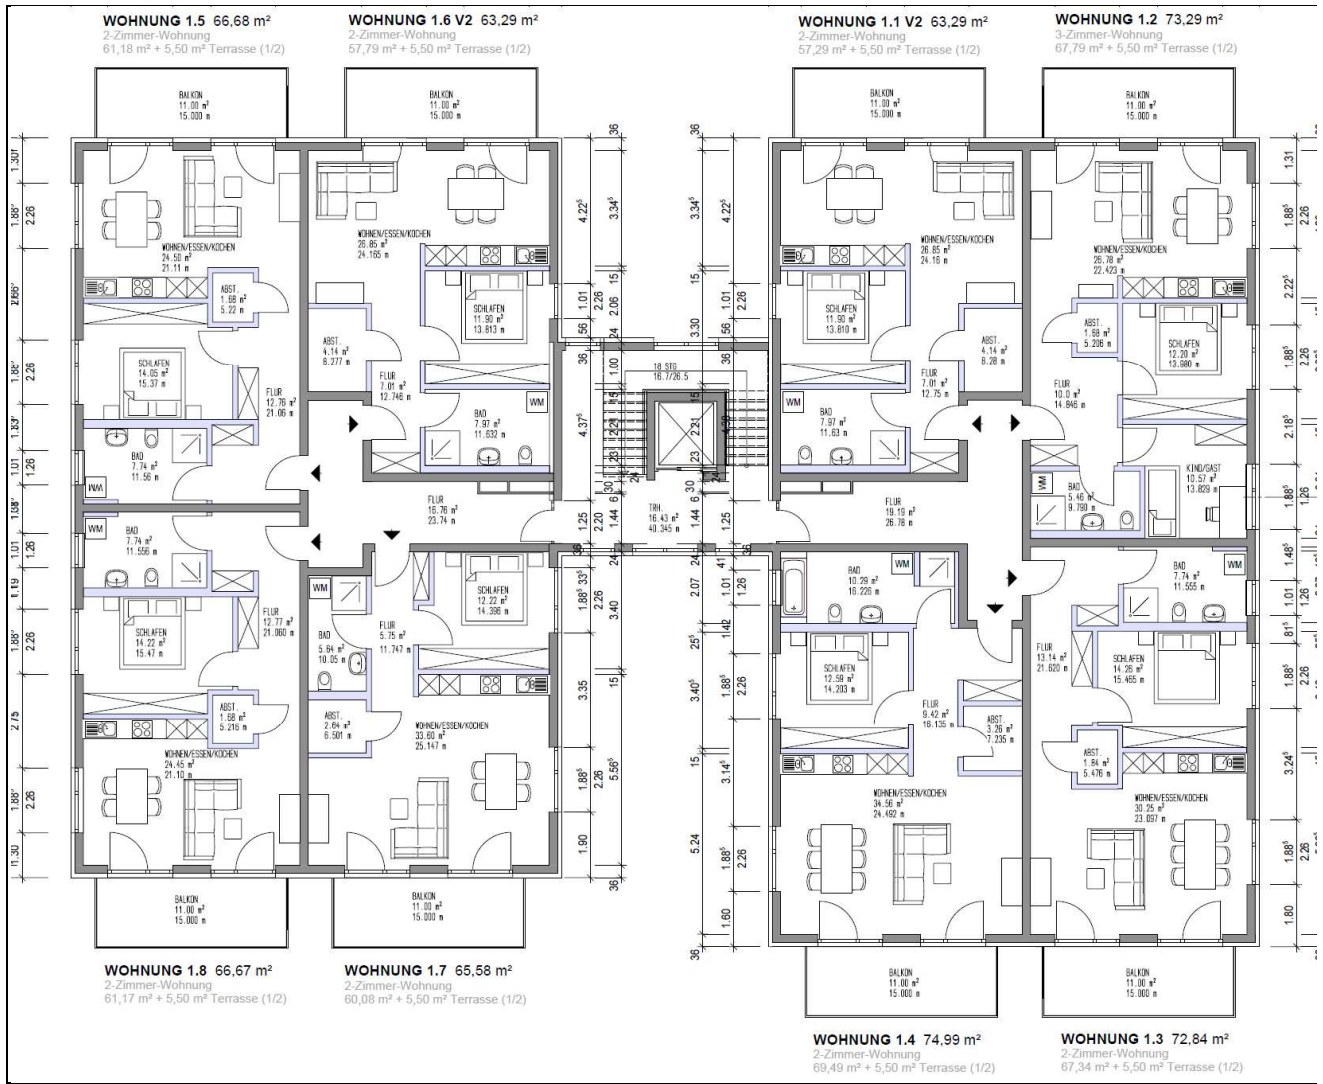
Grundriss Geschoss 1-4.
